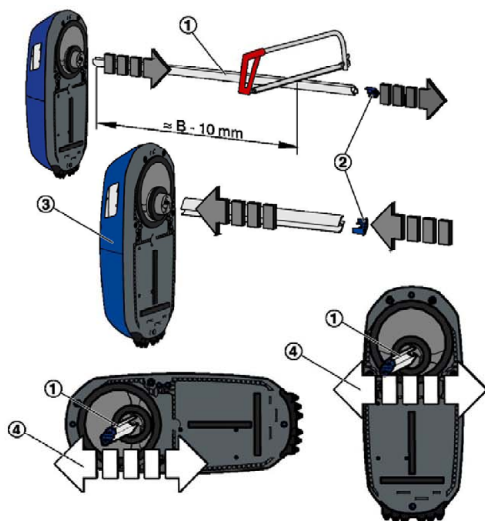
Einbau RM-O-M in horizontaler Luftleitung
